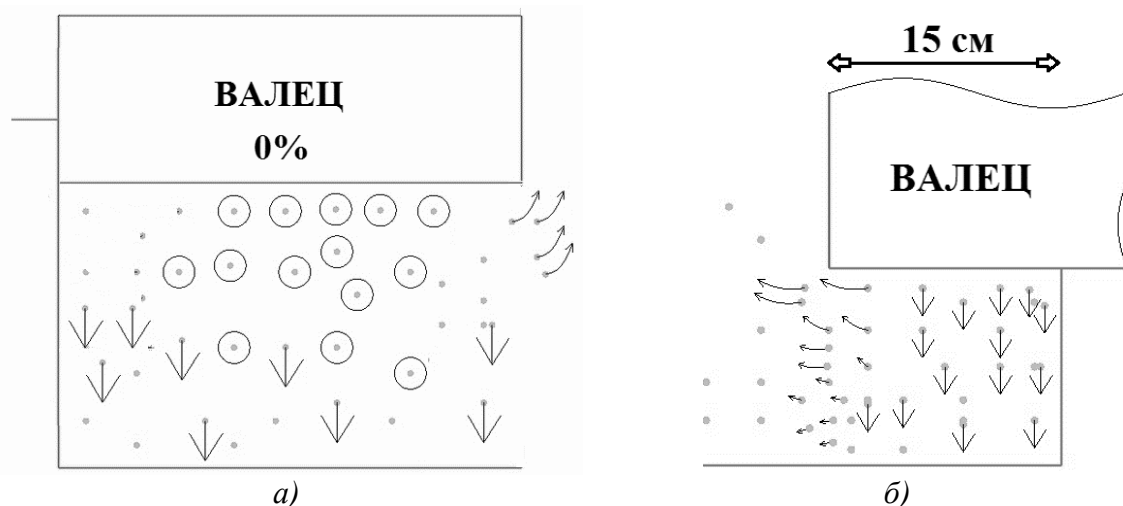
Позиция вальца на стыке (движение на нас): без перекрытия (а), с перекрытием (б)
